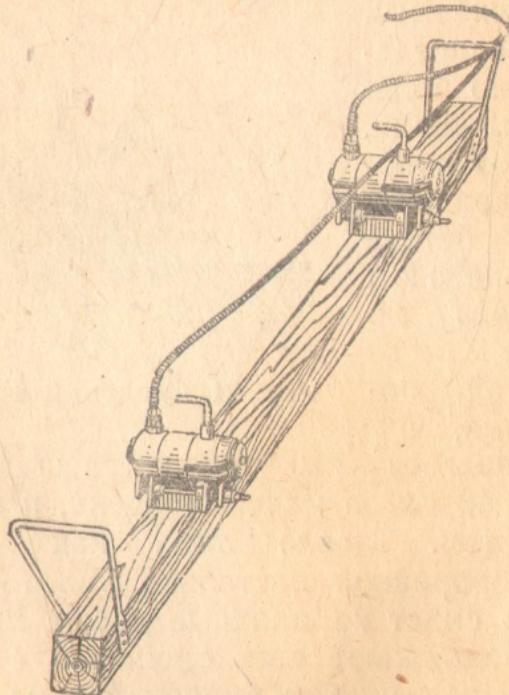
Кустарная виброрейка с двумя тисковыми вибраторами
